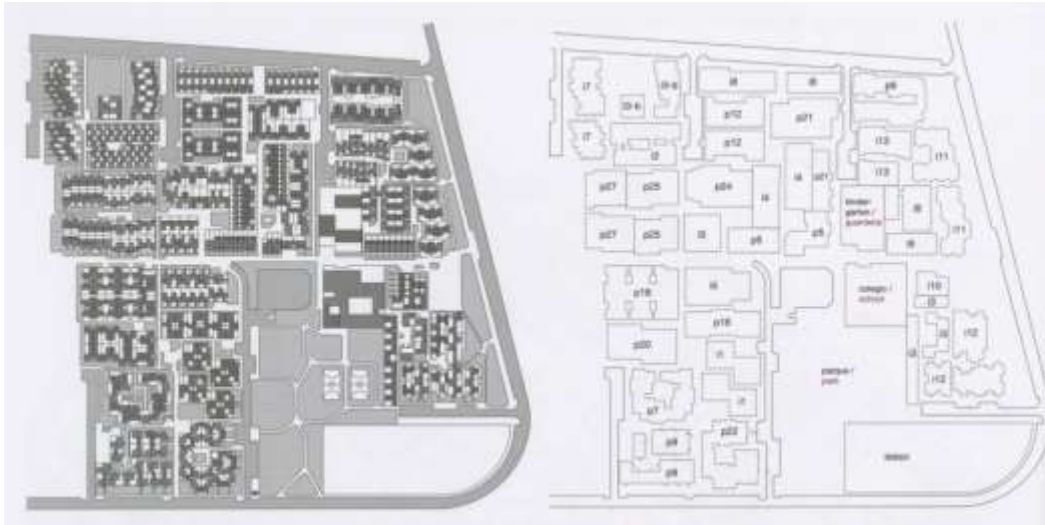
Ramis T. (2012). Collage de los 26 proyectos insertados en el Plan Maestro desarrollado por Peter Land para PREVI
